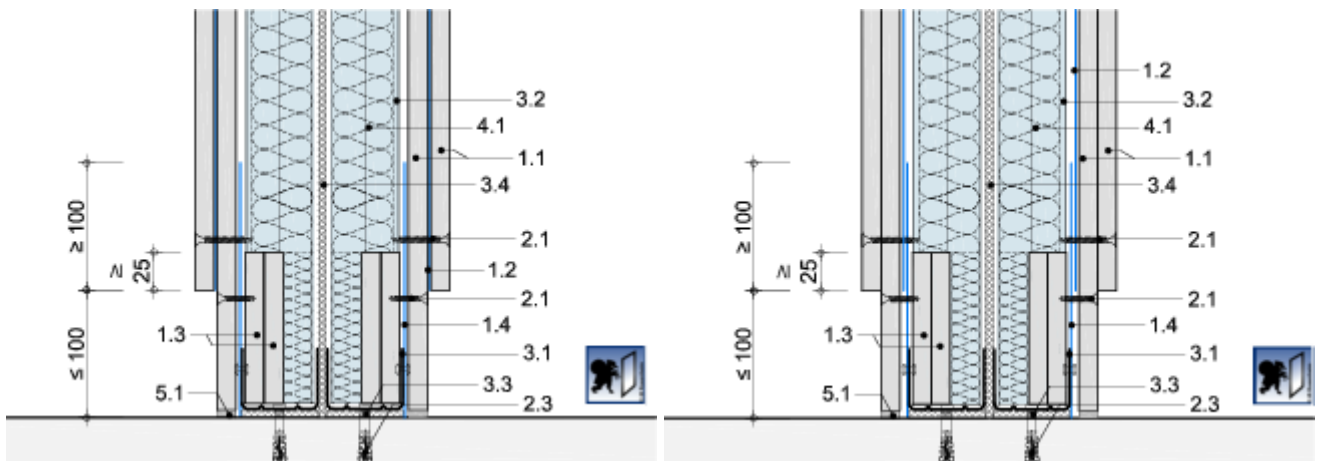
Fußpunkt mit Sockelhinterlegung Einfachständerwand RC 2
